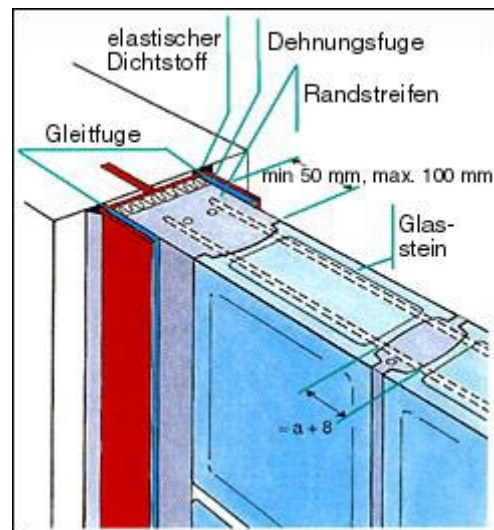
Detall constructiu horitzontal d'una façana construïda amb vidre pavès.
